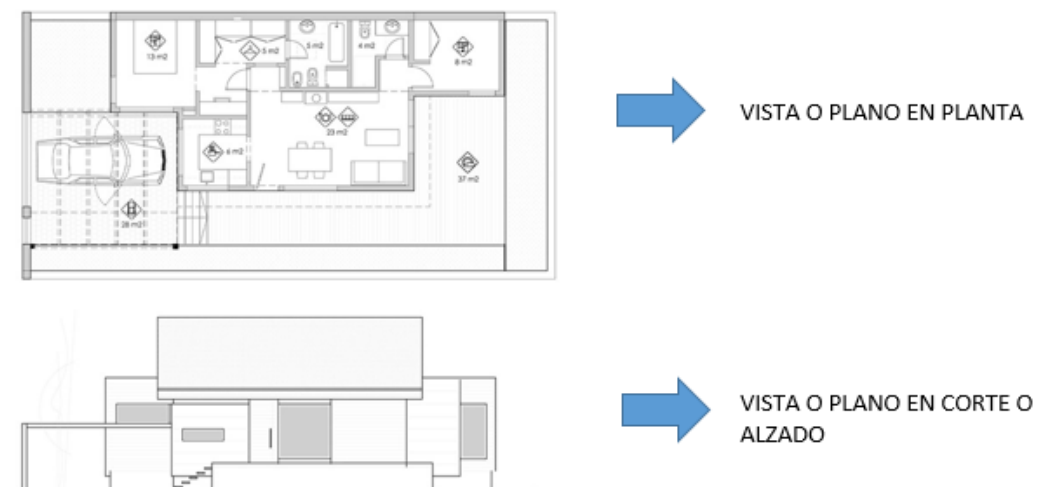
Vista de plano en planta y corte fuente: www.google.com
